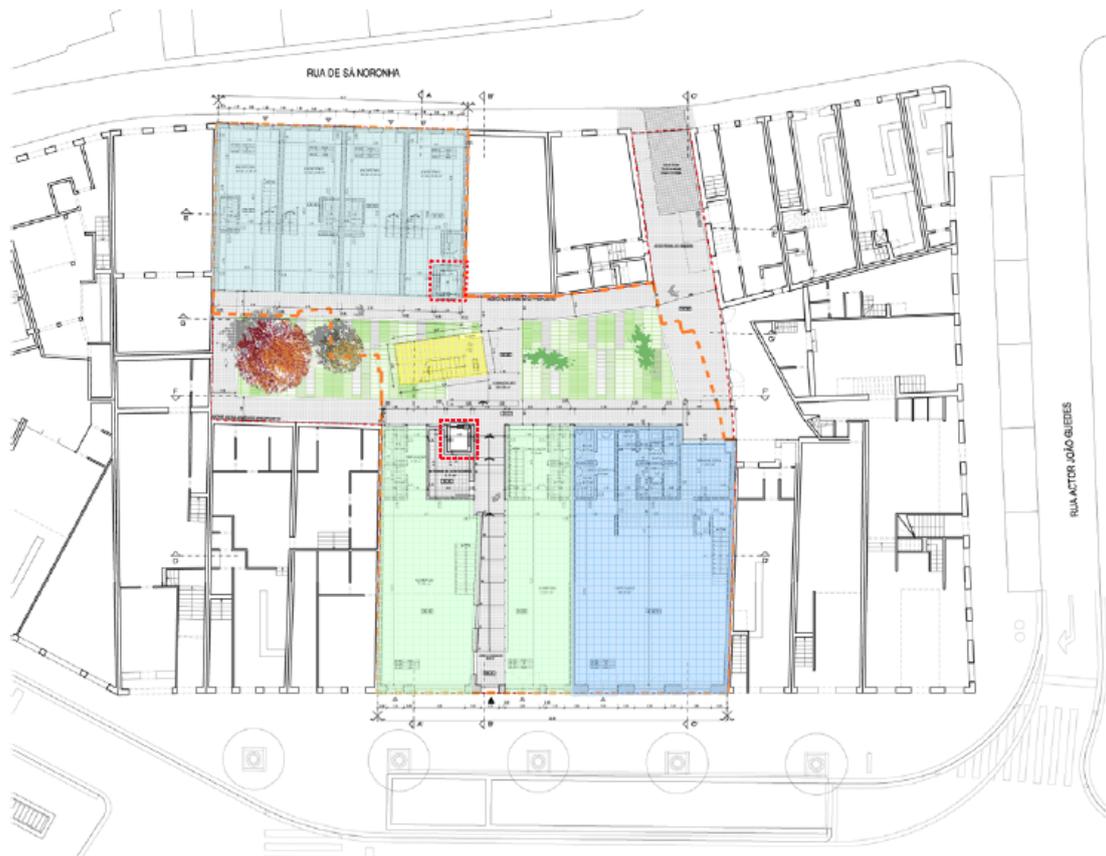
Planta do piso térreo com delimitação de logradouro (SRU, 2007)
